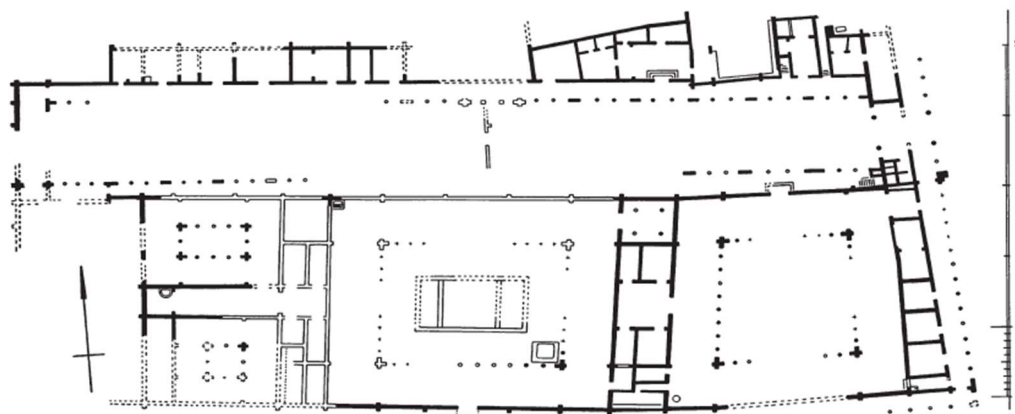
Grundriss Xenodocheion, nördlich oberhalb der Pilgerunterkünfte aus Abb. 34, Abû Mînâ, Ägypten.
